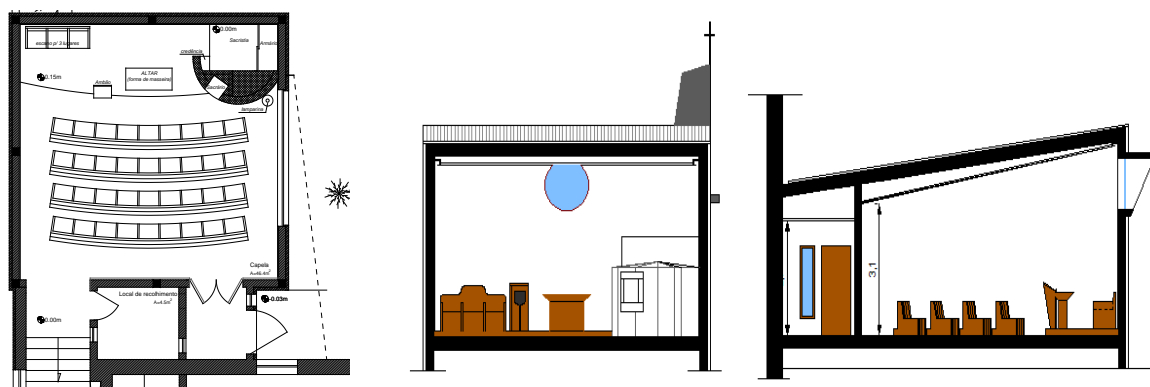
Planta e cortes do projeto de arquitetura da Capela
